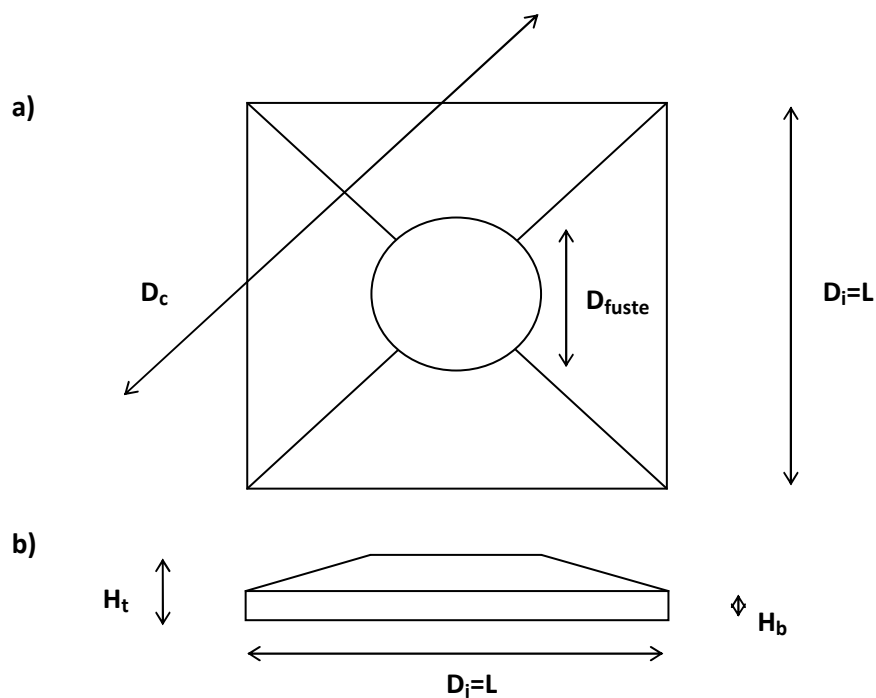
Zapata cuadrada: a) vista en planta, b) vista en alzado.
